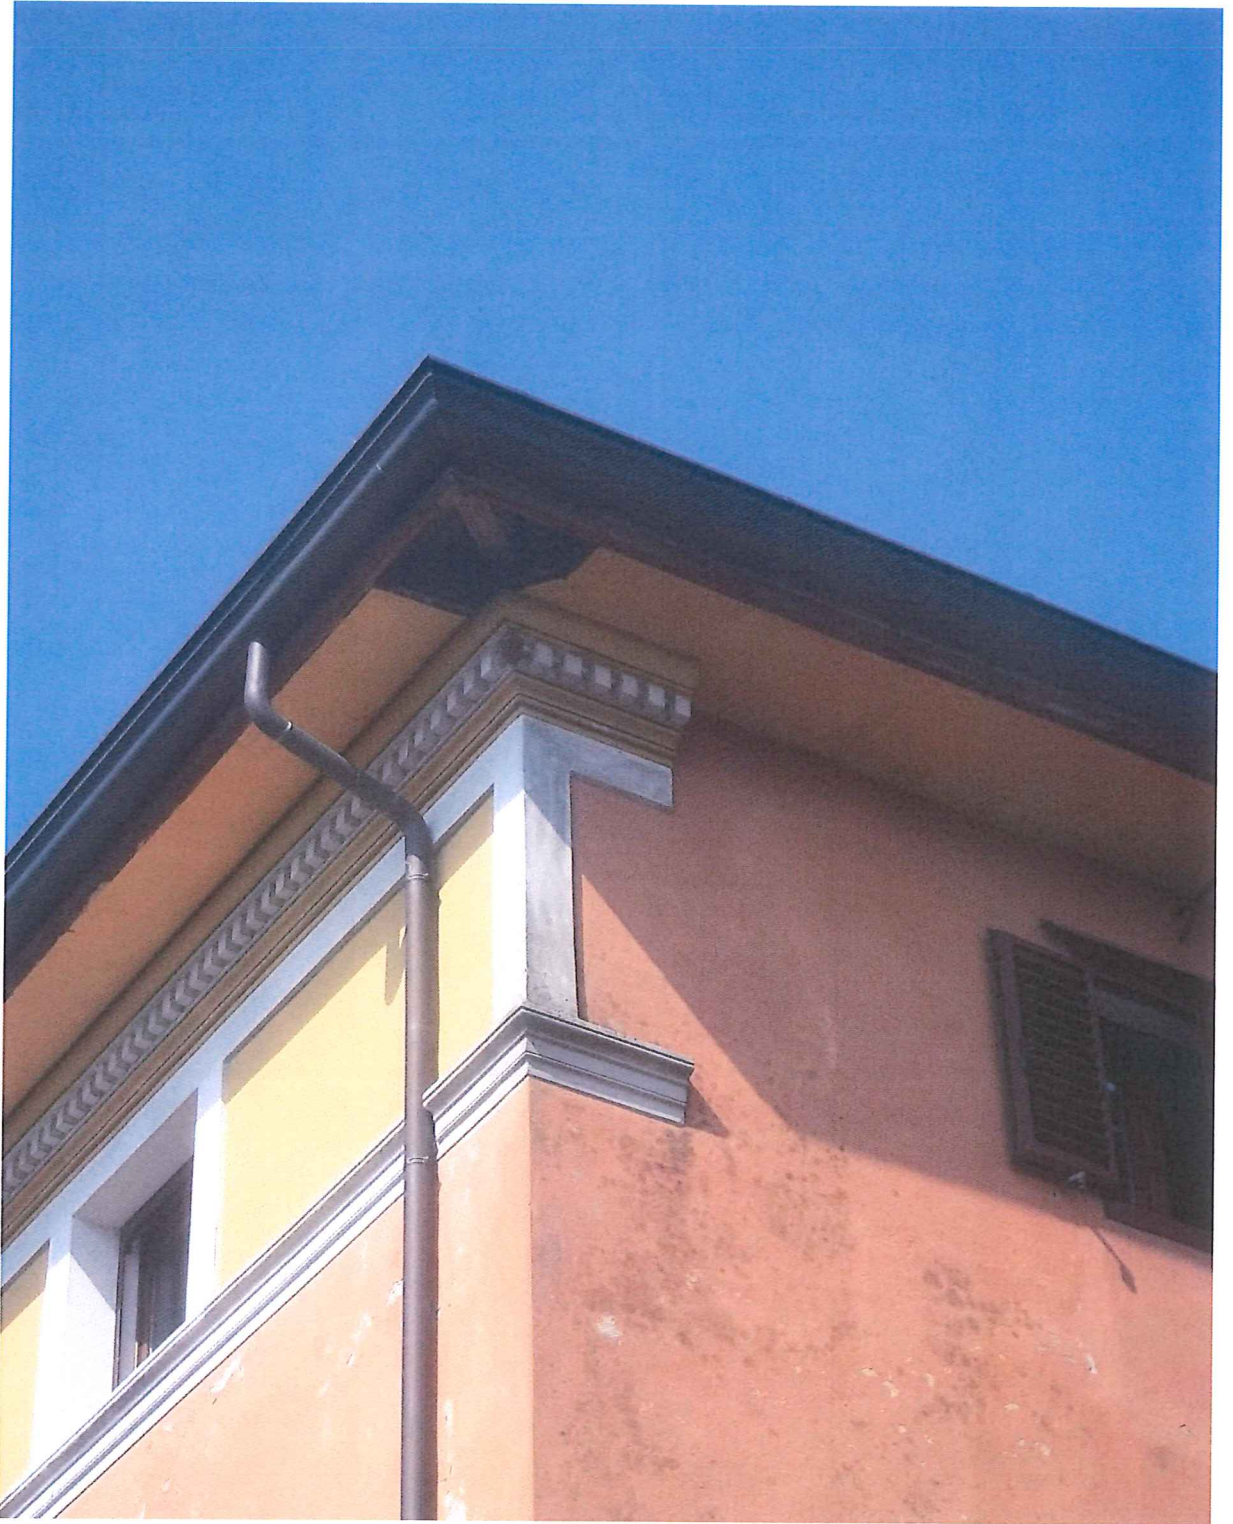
= Prospetto posteriore – Distacco di una porzione di cornice
